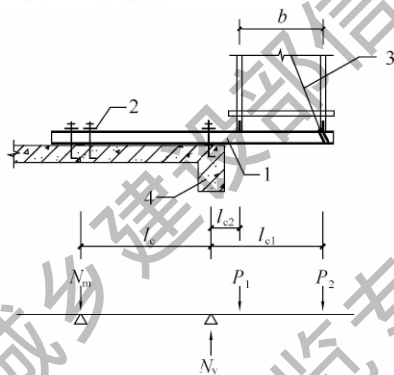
悬挑脚手架型钢悬挑梁构造与计算示意图
